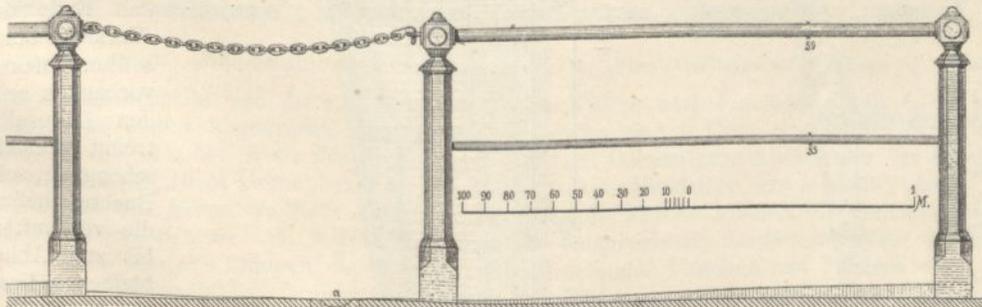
Seitenansicht der eisernen Barriären in der Rinderhalle.
